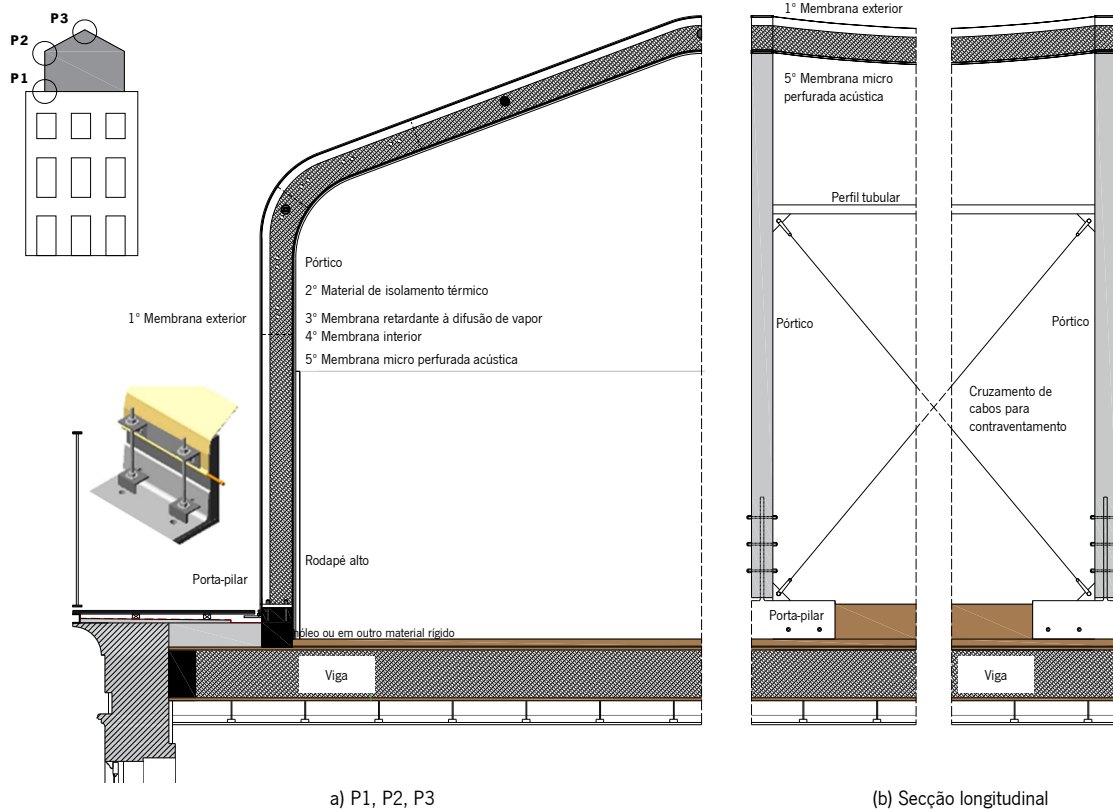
Pormenor construtivos: (a) SAM recuada do alinhamento da fachada; (b) contraventamento dos pórticos.
